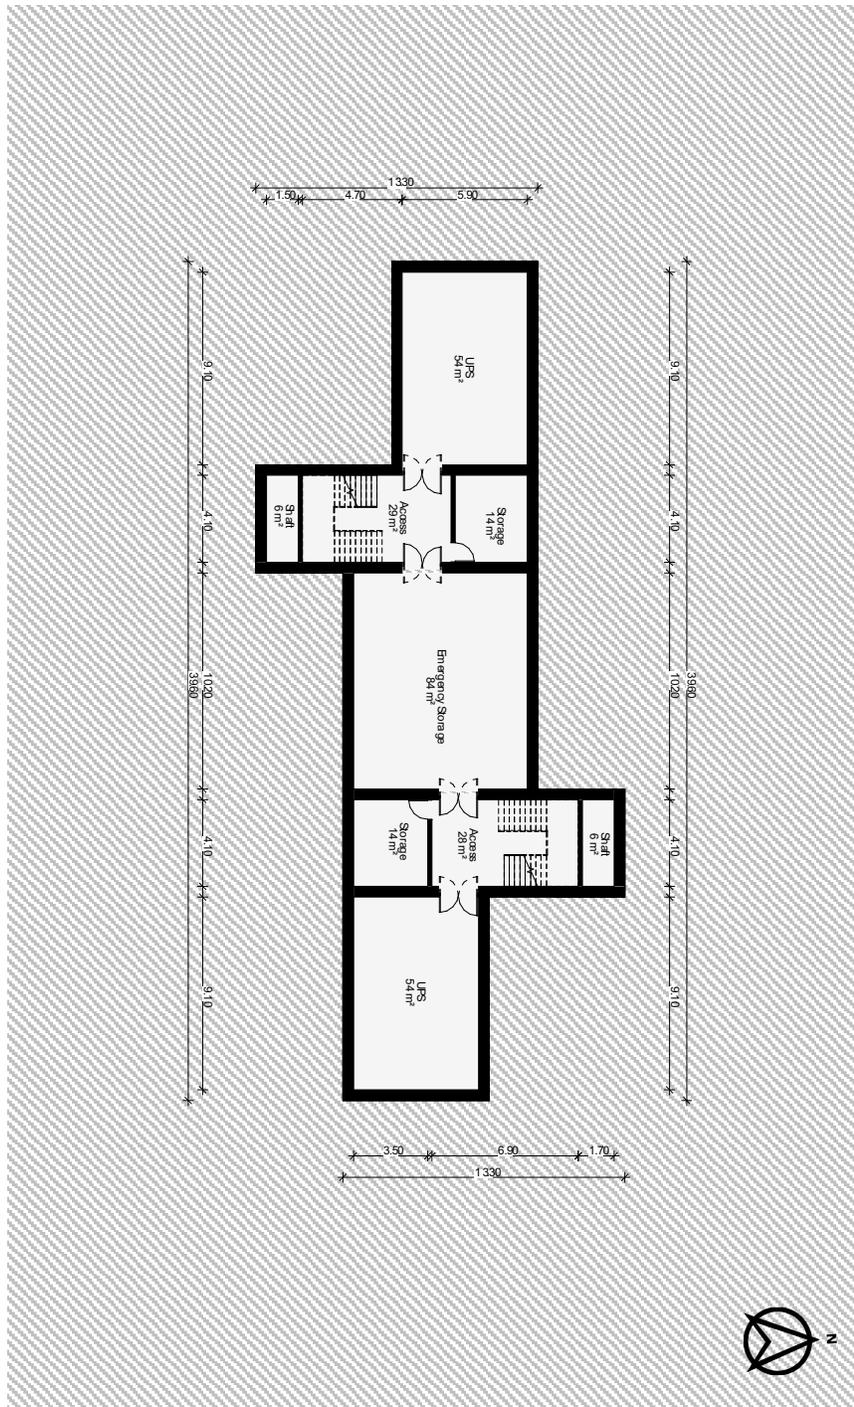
Planta nivel -1 prototipo (Fuente: elaboración propia)
